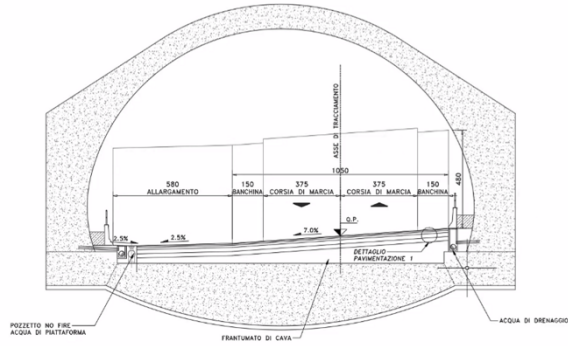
c - Sezione tipo C1 in galleria artificiale Torrette 1.
